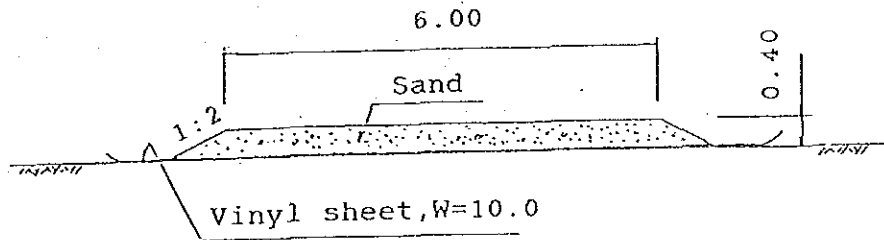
(A) 仮設道路標準断面図 (タイプ1)
